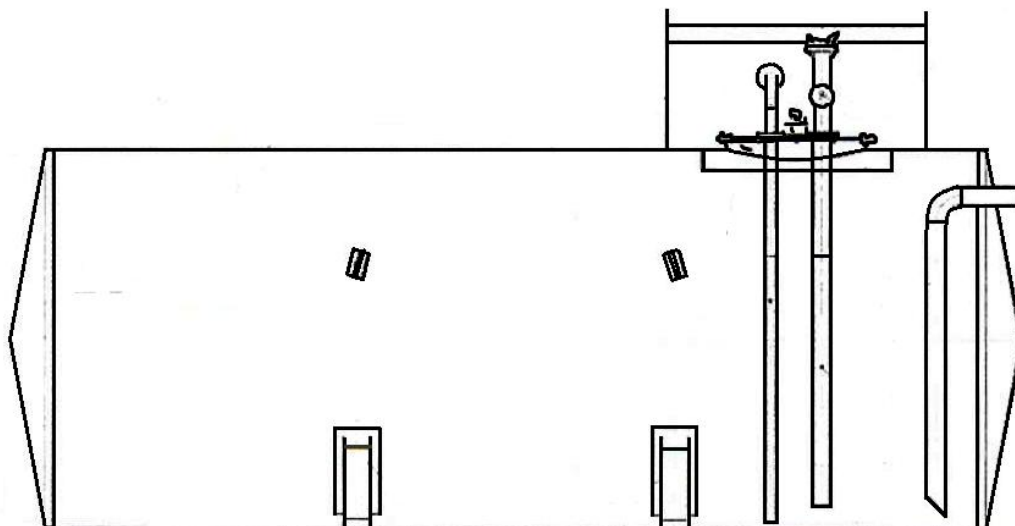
Эскиз резервуаров РГС-20 №№ 635, 636
